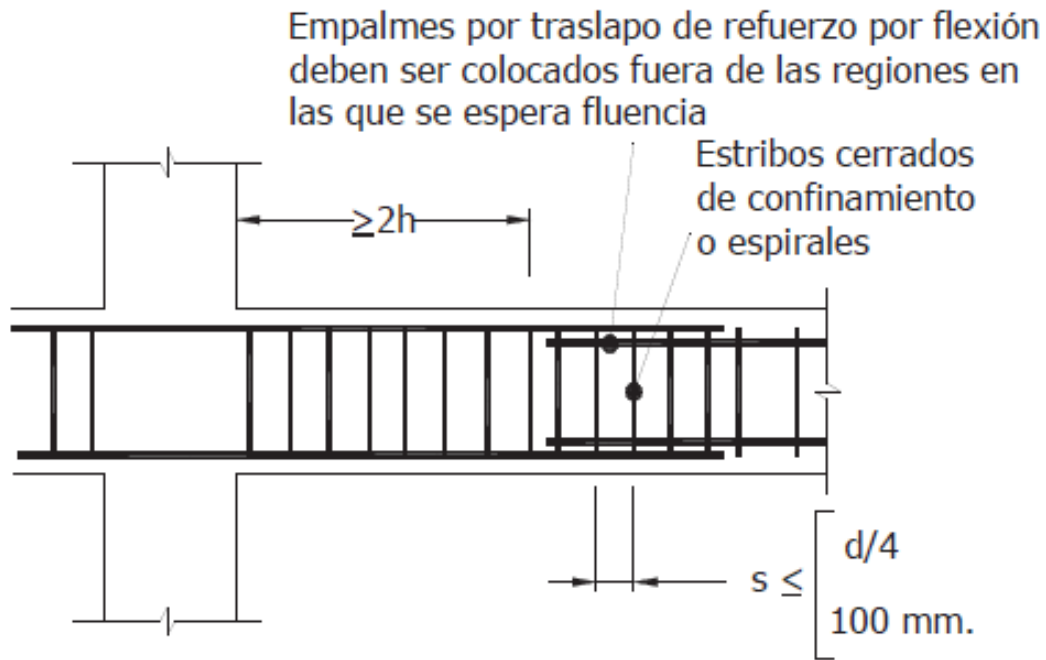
Confinamiento en traslape de varillas de refuerzo longitudinal
